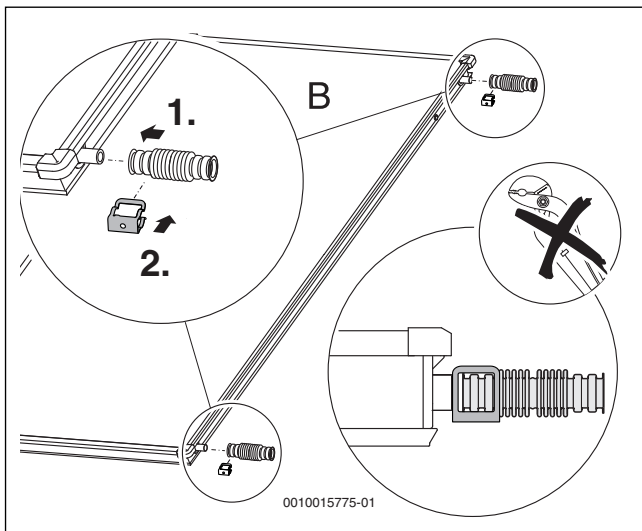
Montar el set de conexión hidráulica en el colector izquierdo
